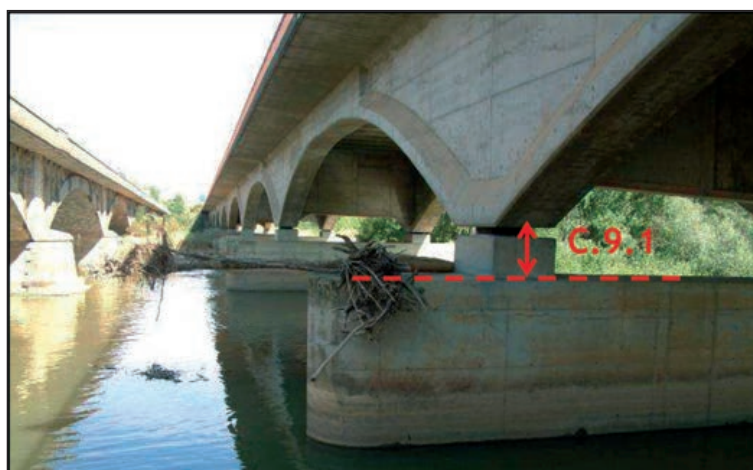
EVIDENCIA DE UN NIVEL MÁXIMO DEL AGUA EN LAS PILAS.
